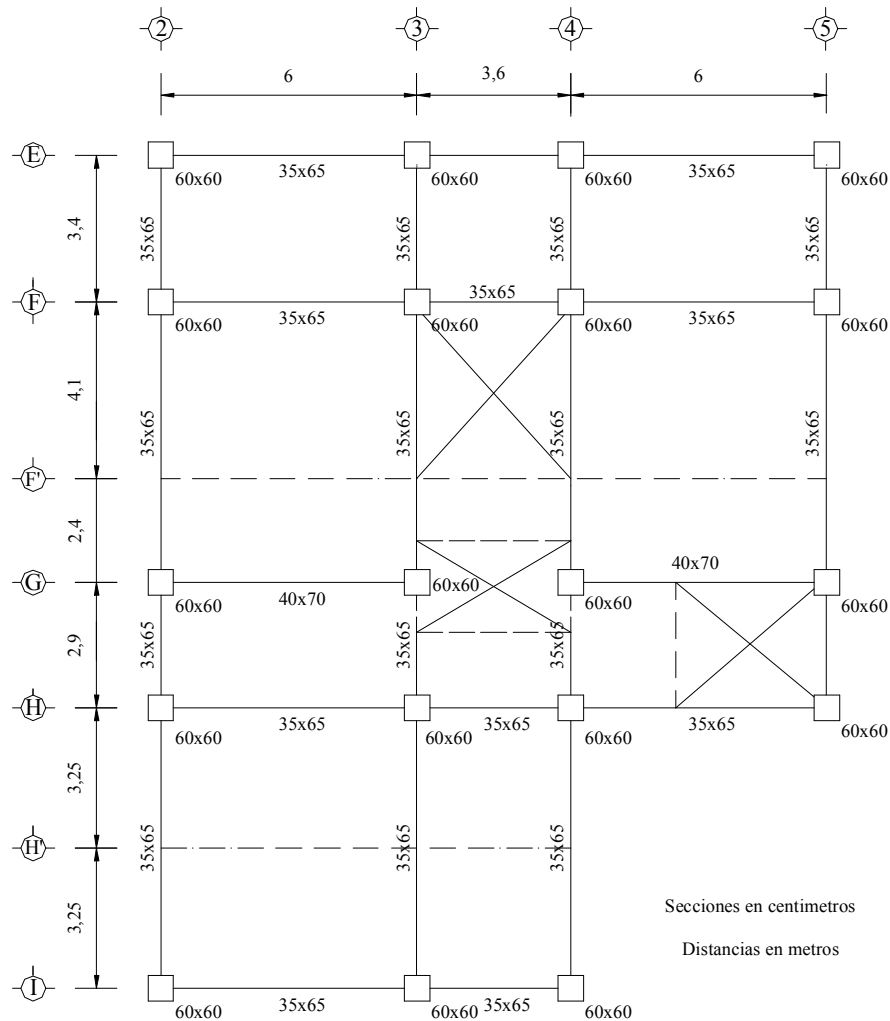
CROQUIS DE ESTRUCTURACIÓN DEL SÓTANO Y PRIMER NIVEL DEL EDIFICIO
